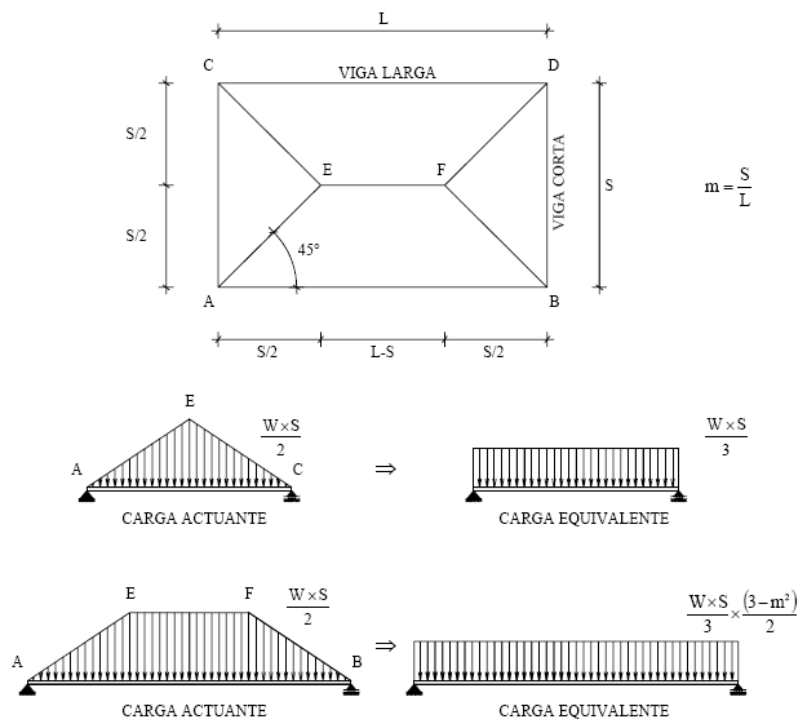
Carga Actuante Sobre las Vigas, Fuente: Predimensionamiento Estructural, Patricio Vásquez López, Ing. Civil.
